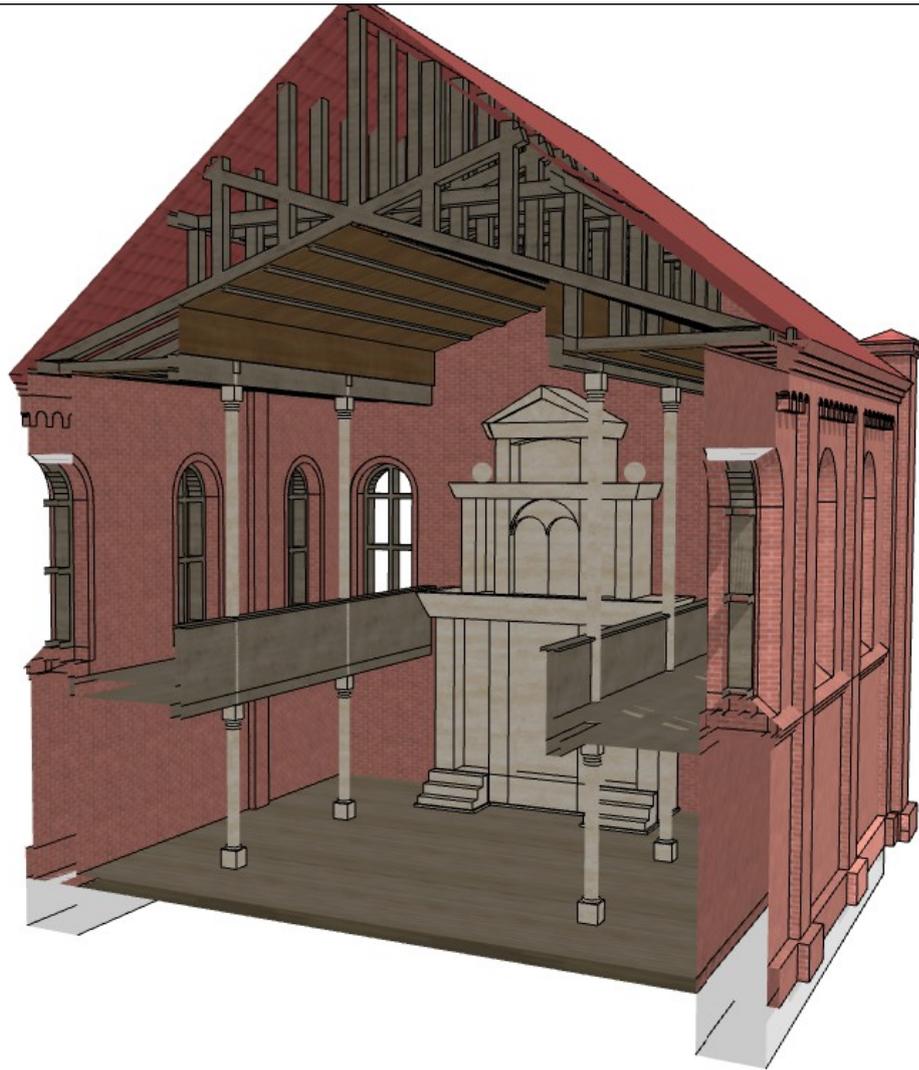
Schnitt, quer mit Einblick in die Dachbalken
